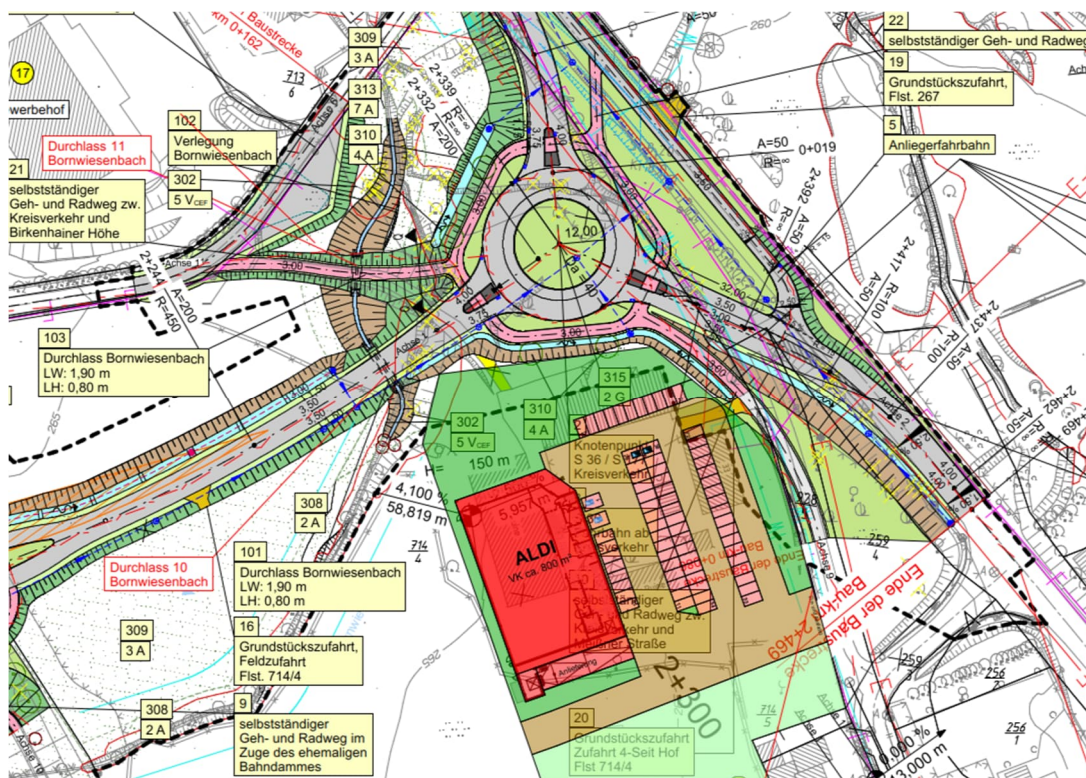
Feststellungsentwurf 1. Tekturplanung „S 36 westlich Wilsdruff“ Landesamt für Straßenbau und Verkehr einschl. Entwurfsplanung ALDI-Markt (Zirpel & Pautzsch (03/25)
